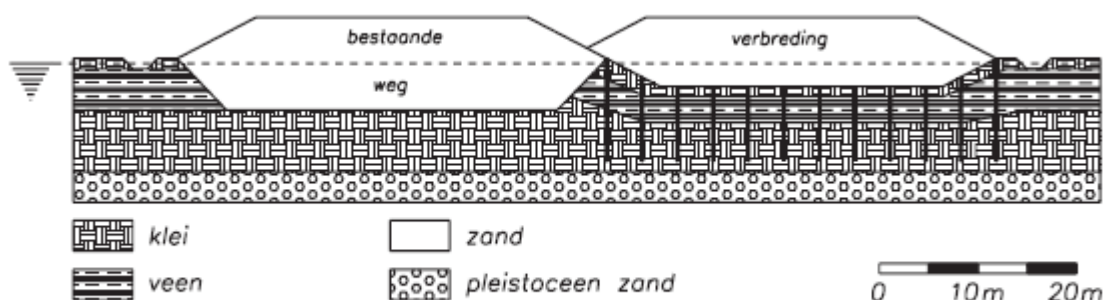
Installeren van verticale drains vanaf de werkvloer.
